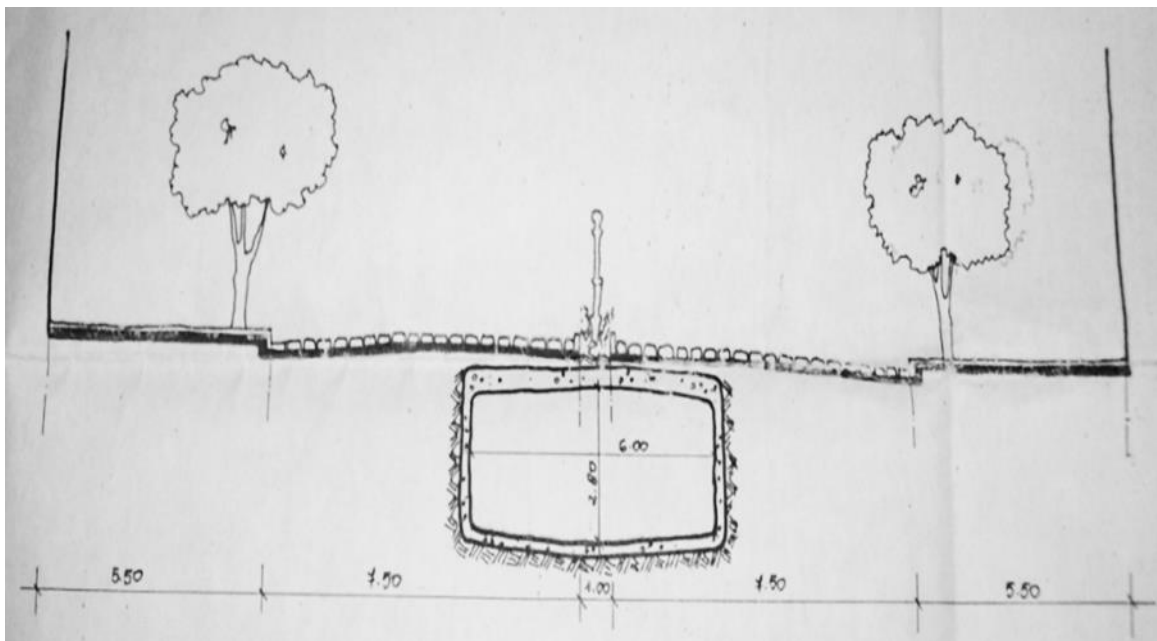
Projeto de canalização e tamponamento para o Córrego das Lajes
